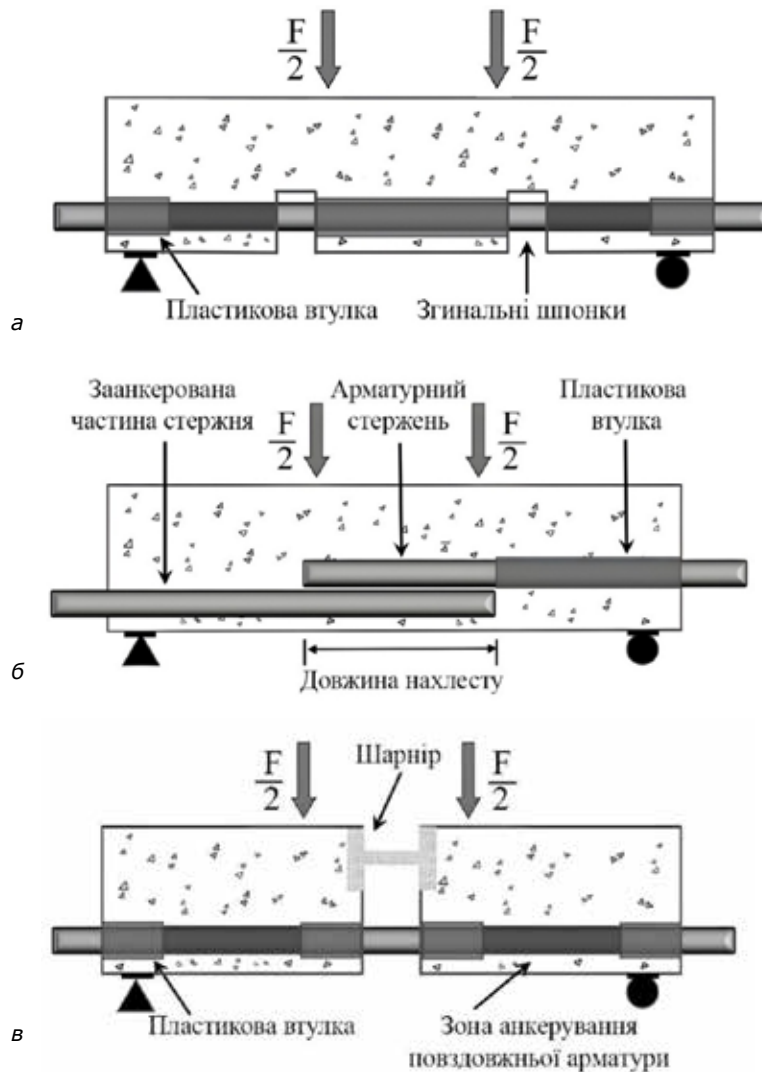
Схеми балкових випробувань для дослідження зчеплення арматури з бетоном [25]: а) анкерної балки; б) зі стержнями внахлест; в) із шарніром посередині
